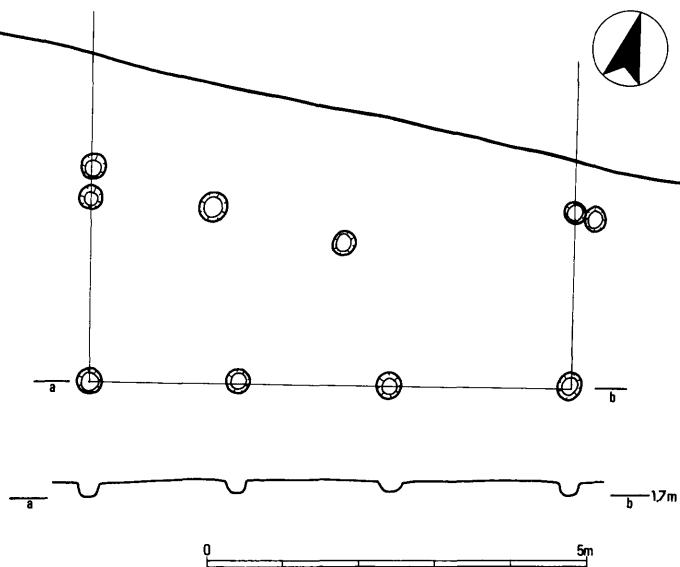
B 2 区掘立柱建物 S B 108平面・断面図 (1:100)
